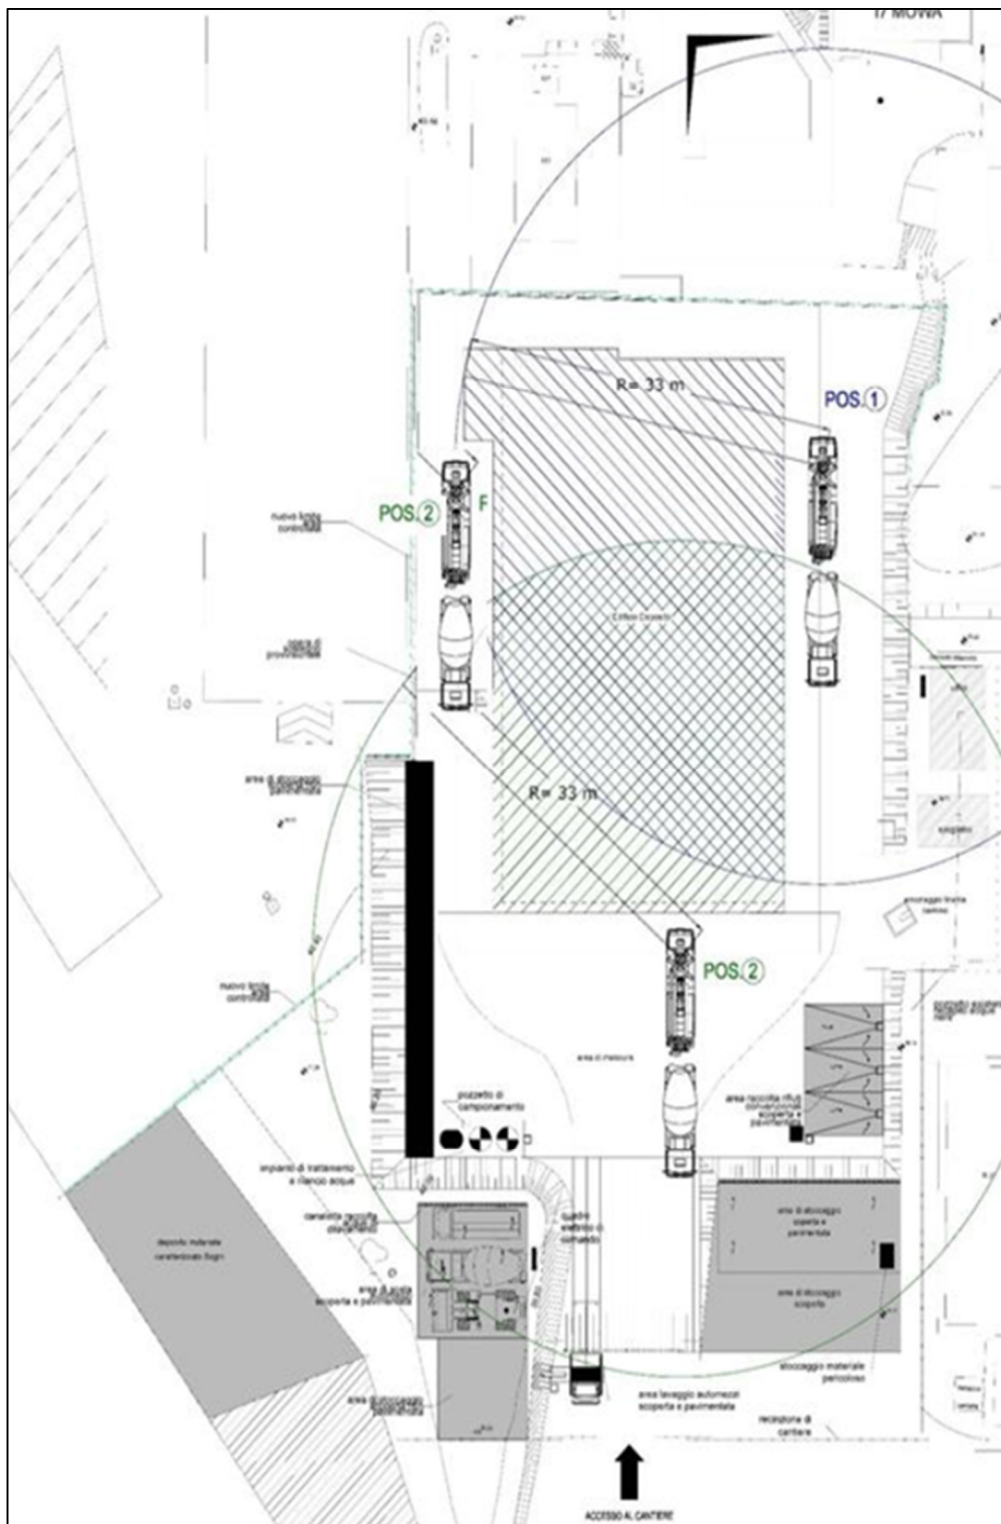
/2: Layout disposizione autopompe per getto platea di fondazione
